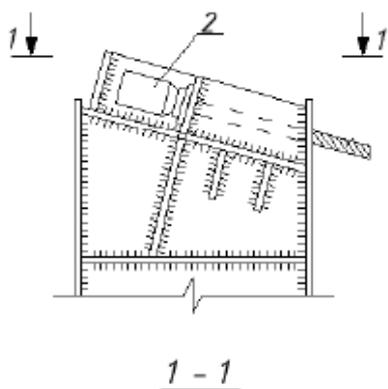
Крепление вантовых канатов к железобетонным конструкциям насквозь с помощью анкеров: 1 – ванты; 2 – анкерное устройство
